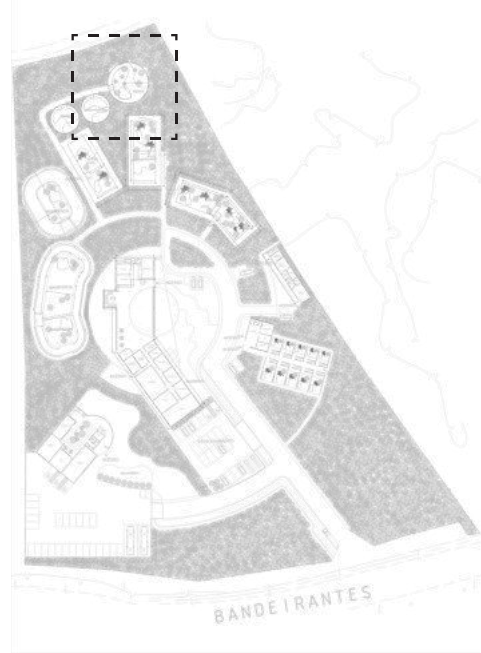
PLANTA BAIXA -- RECINTO DE PEÇONHENTAS
